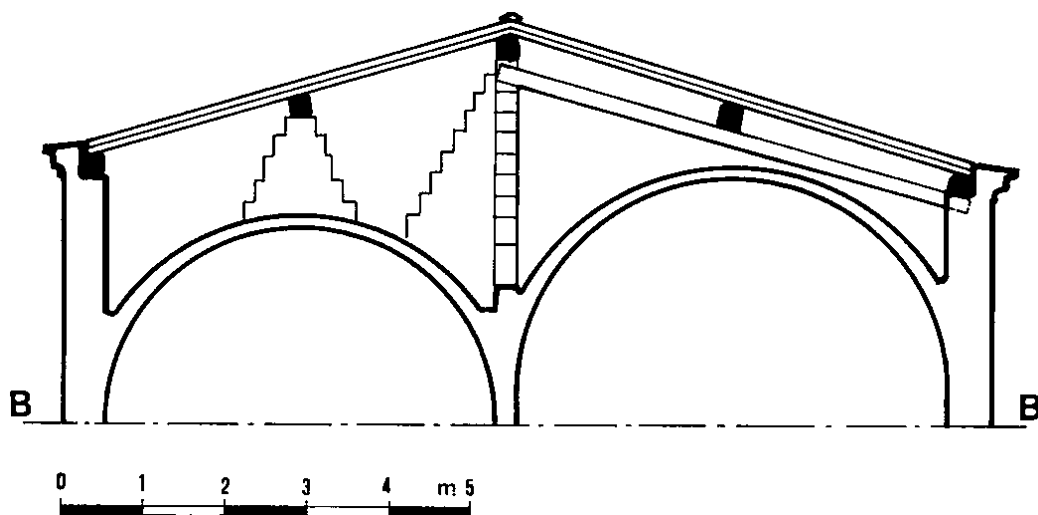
Sezione tipica di un tetto ligneo a falde (Randazzo 1988).
